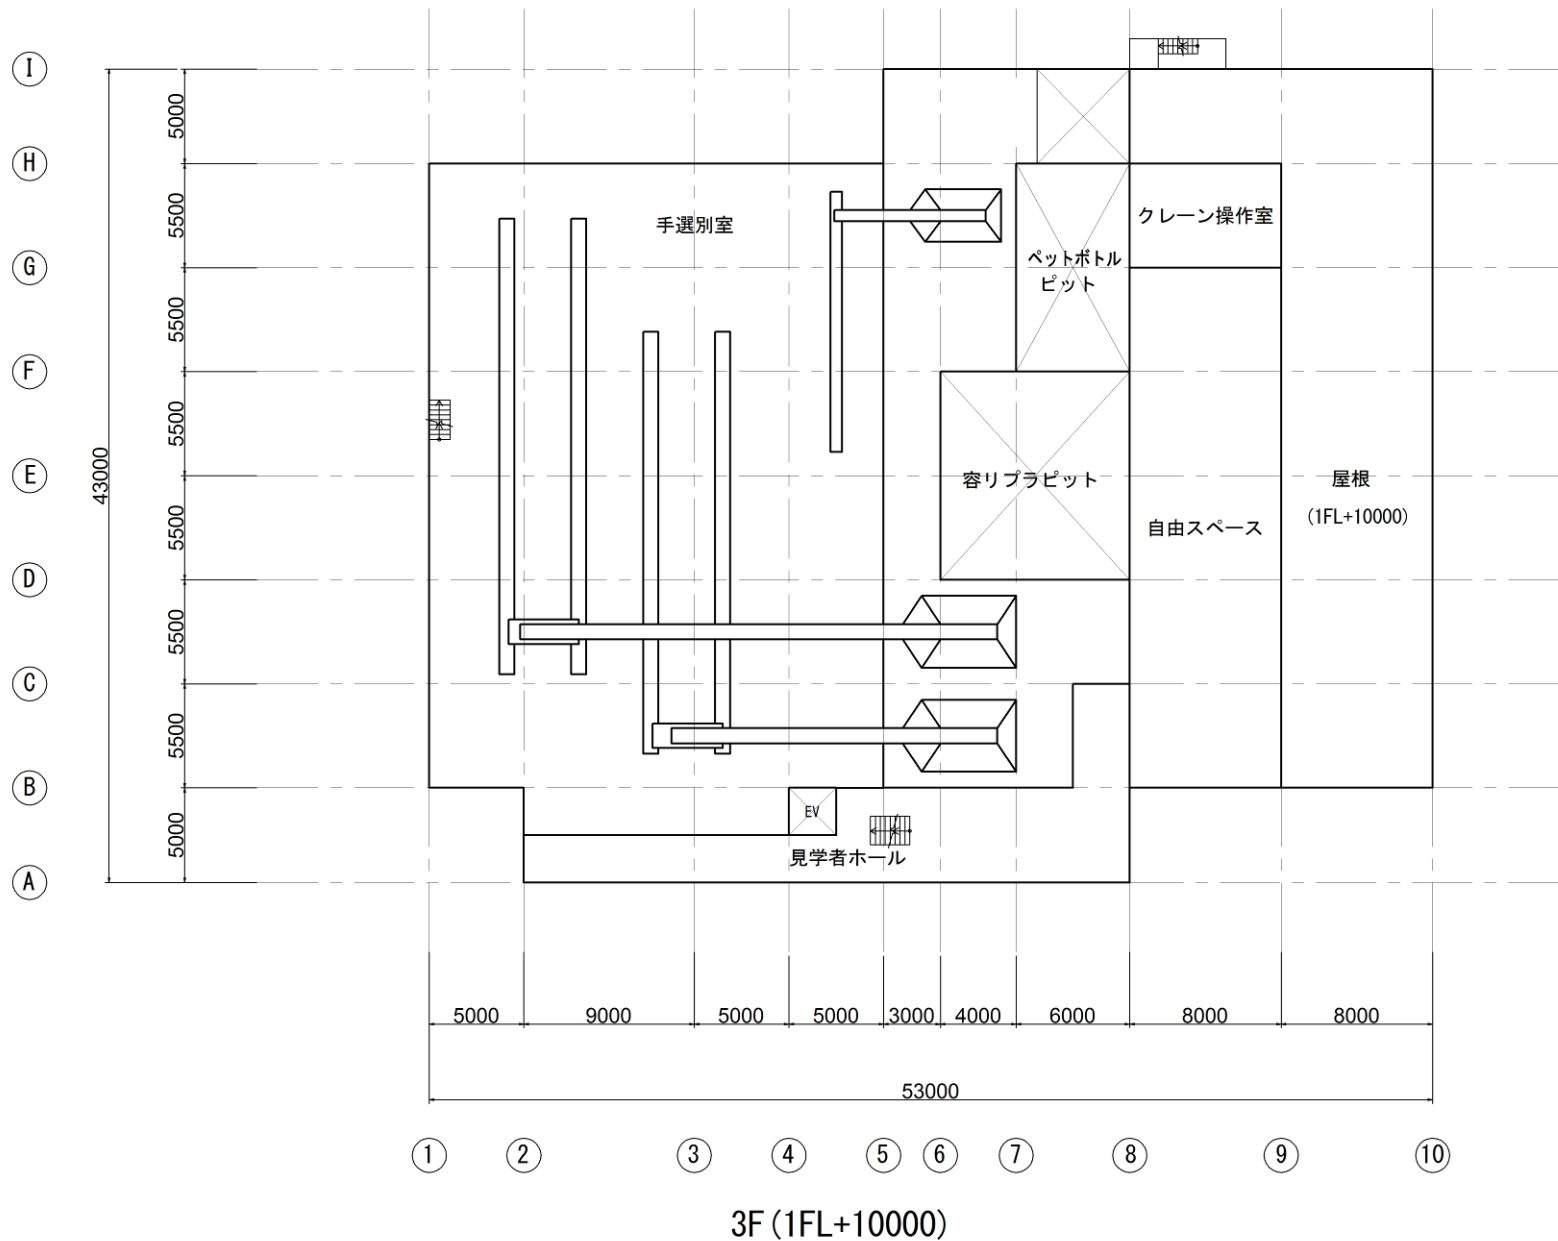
各階平面図 (案) (3階 : S = 1 : 400)
